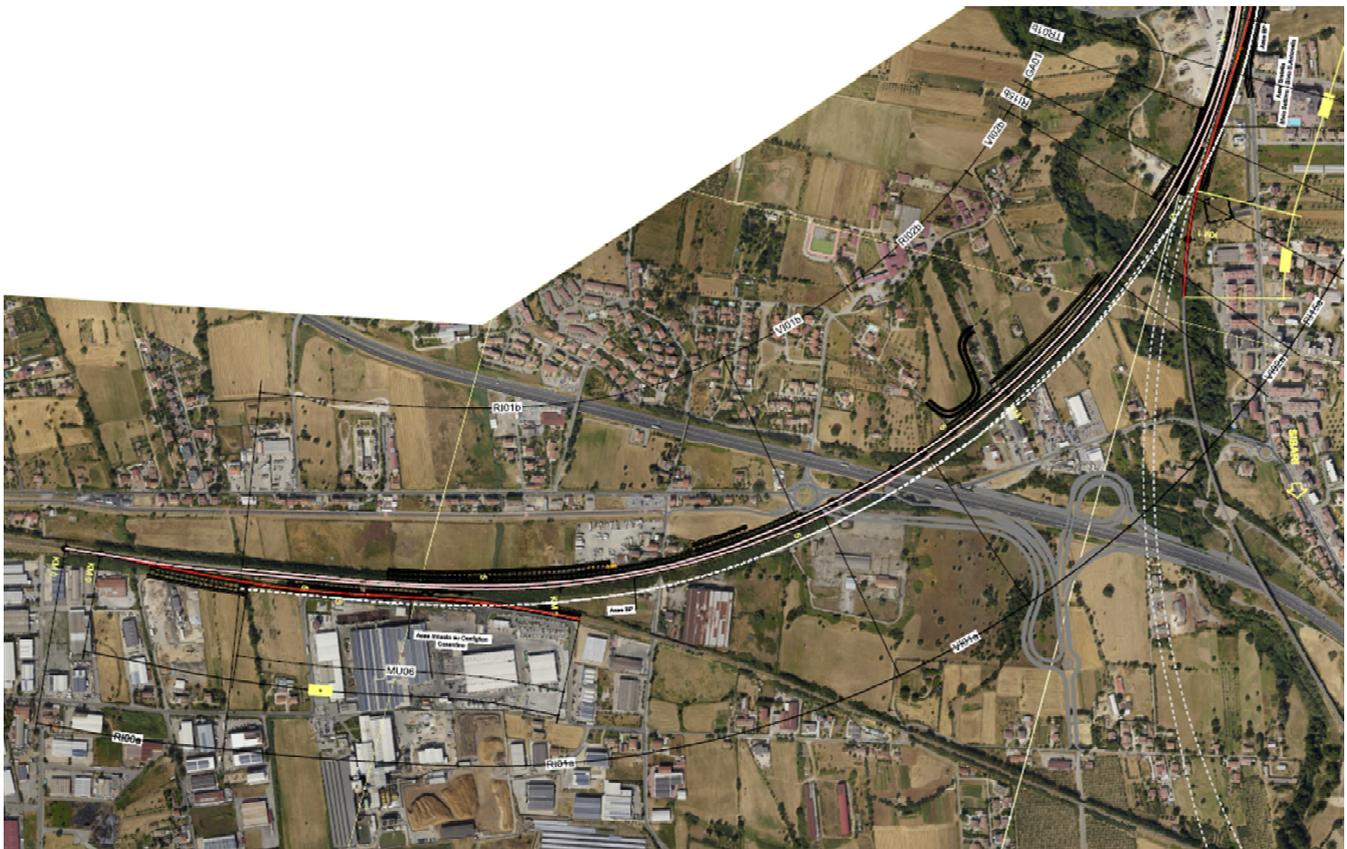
Stralcio planimetria su ortofoto da inizio tracciato alla GA01, compresa la variante 1 Linea Sibari
